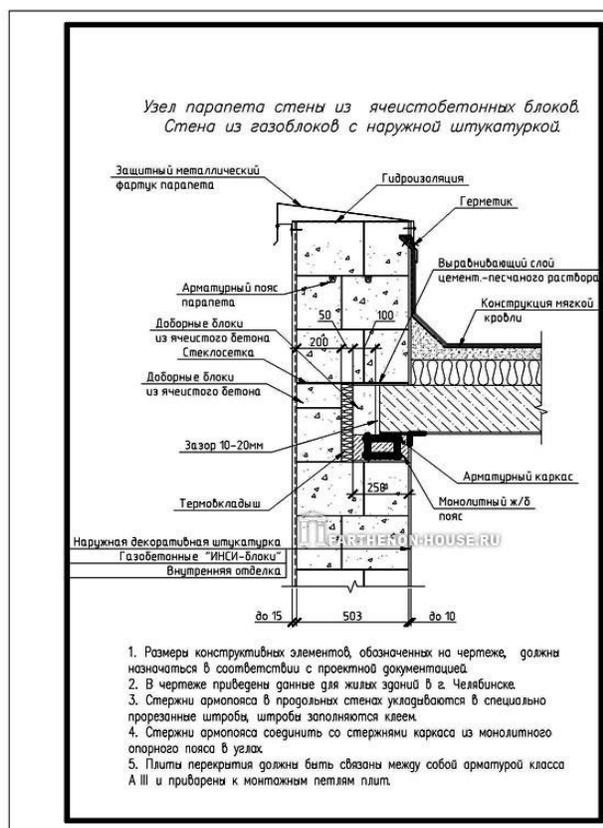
(«Узел выполнен на основе интернет ресурса: URL - [https://free-dwg.com/engineering\\_details/](https://free-dwg.com/engineering_details/))
